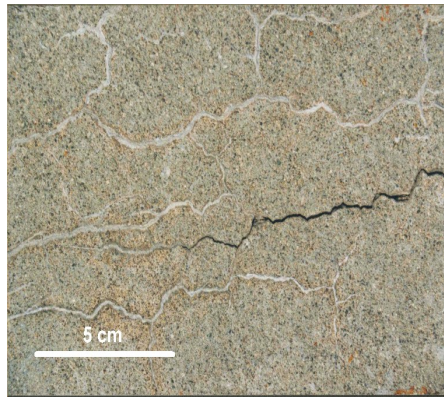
Surface de béton *fortement fissurée* avec des efflorescences (*blanches*) le long des fissures fermées et avec des fissures béantes (sombres) >0.5 mm
